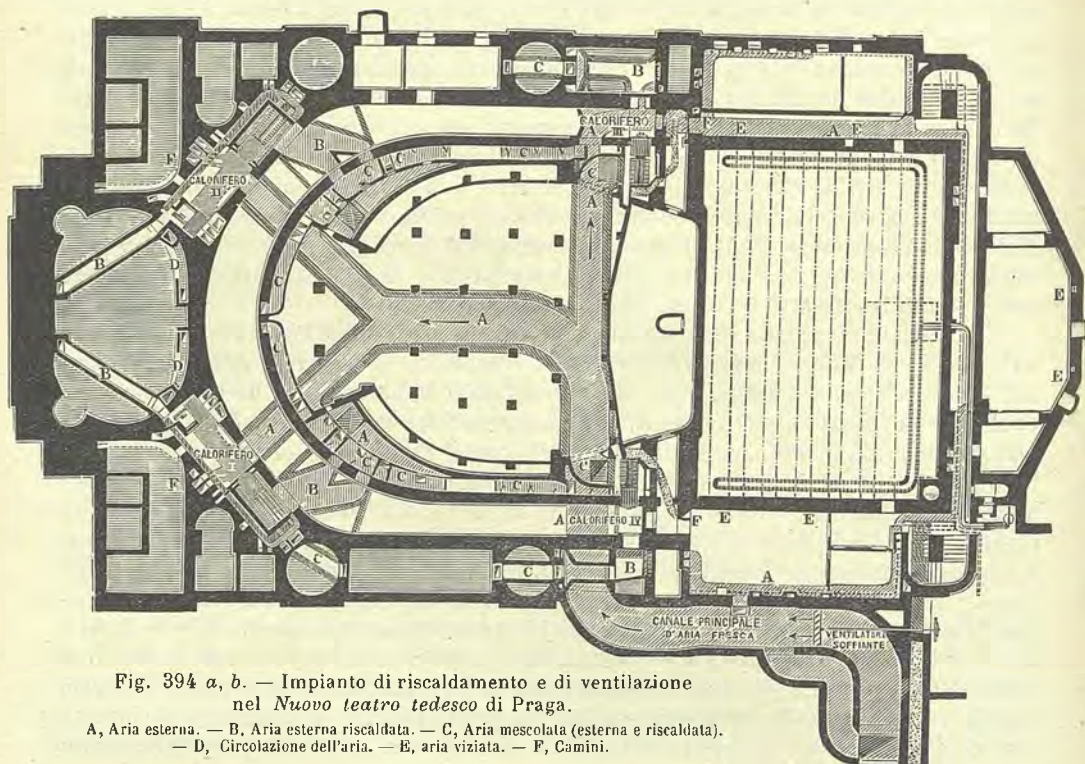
a, b. — Impianto di riscaldamento e di ventilazione
